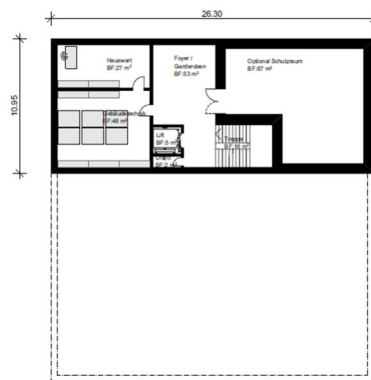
Disposition 02 | Grundriss Untergeschoss
